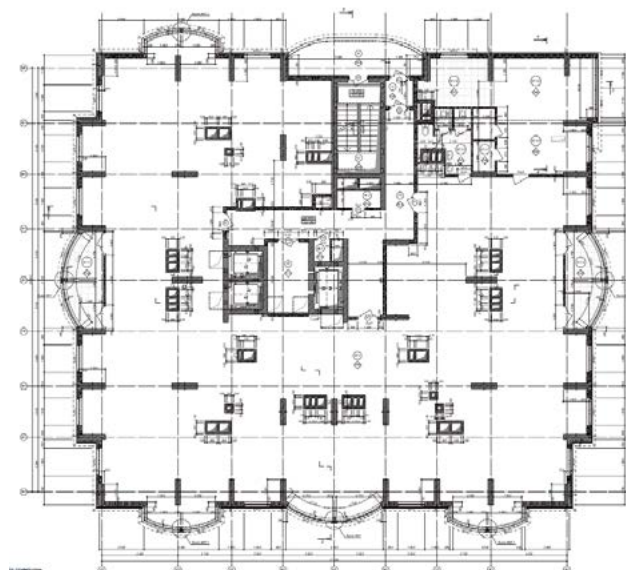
План этажа секции № 1 на отметке +78.80
